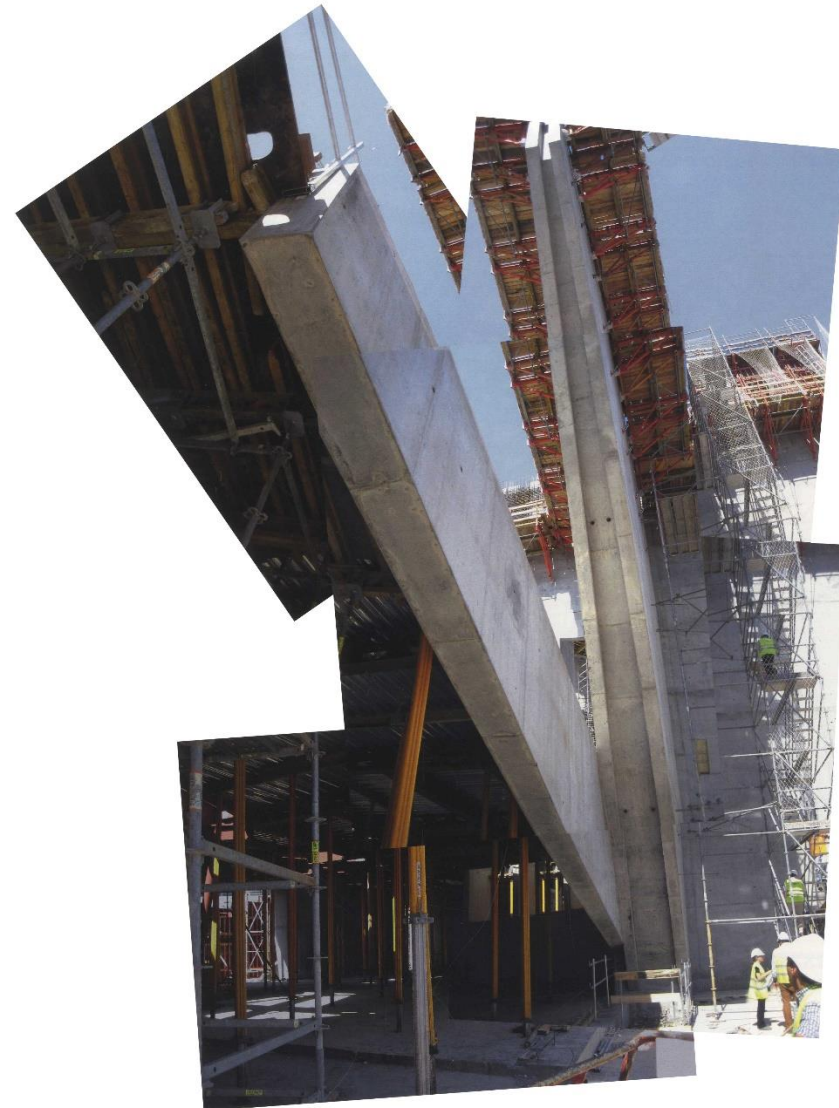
Vista del muro de planta baja y el forjado de la planta mezzanine.
